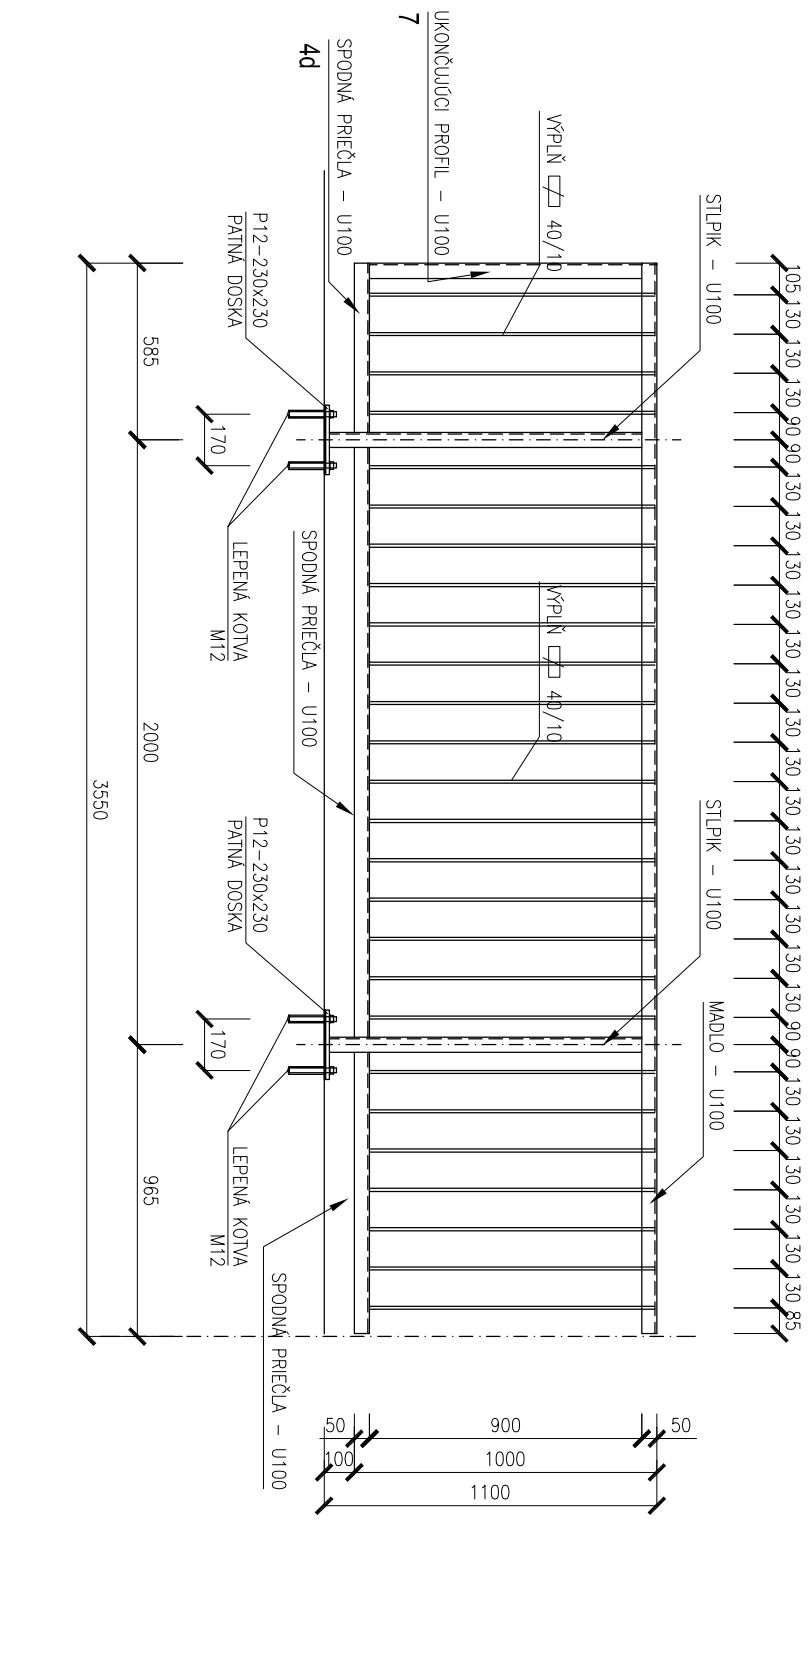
DETAIL ÚCHYTU ZÁBRADLIA M 1:5
